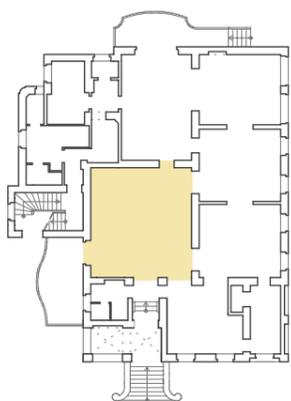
Heizkörper in der Halle – Raumbuch.
